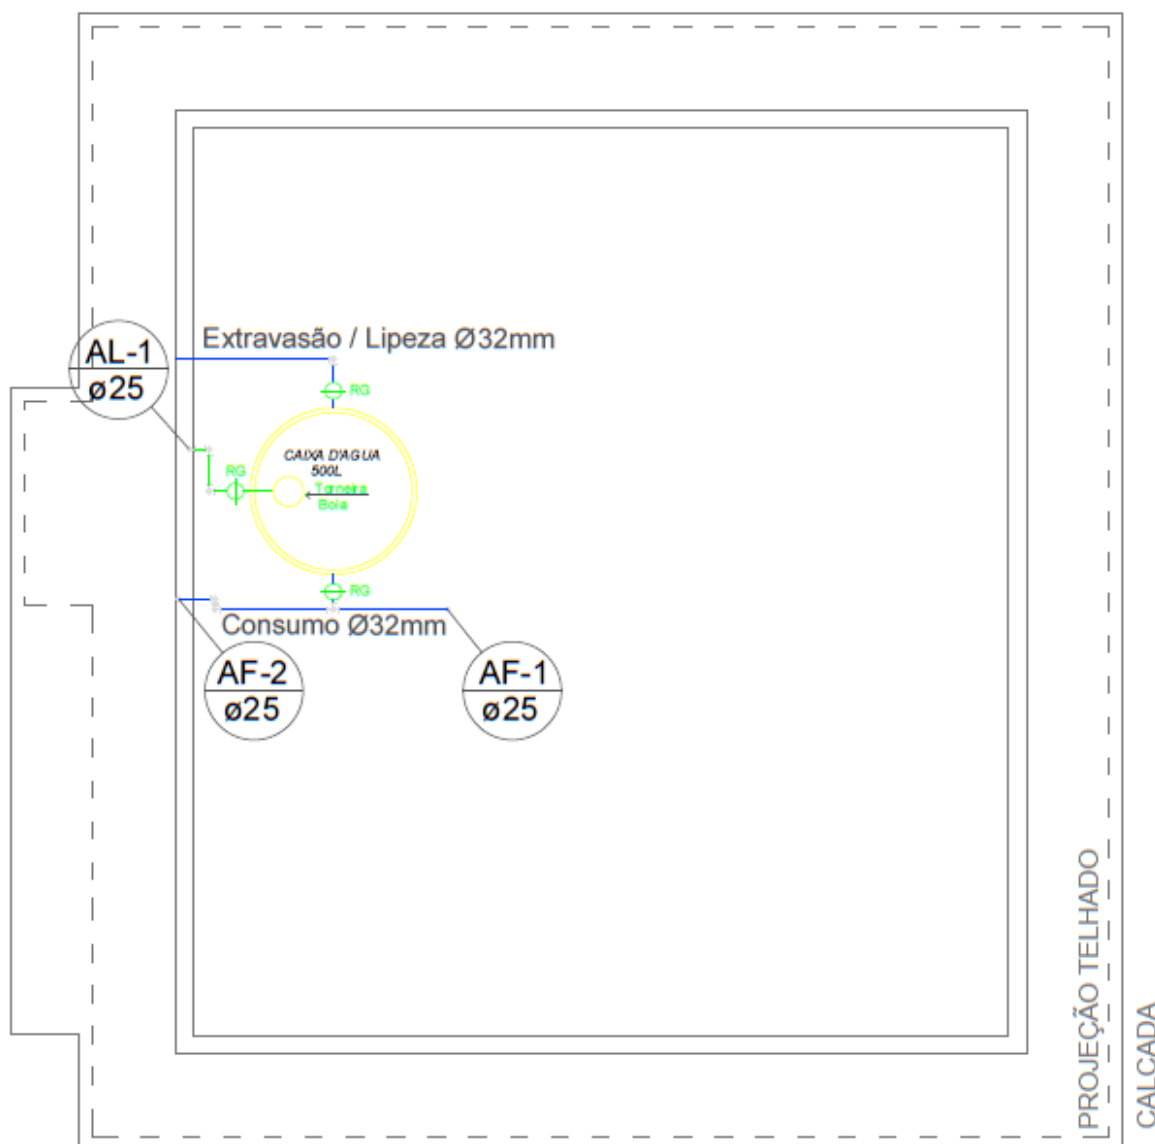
Planta Baixa Cobertura, Detalhamento do Barrilete
